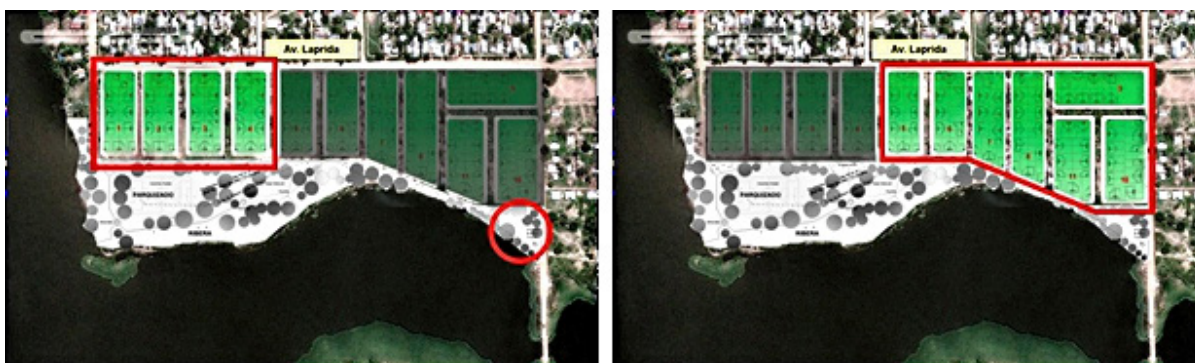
Instancias de la ejecución de viviendas. Fuente: SUOPE
